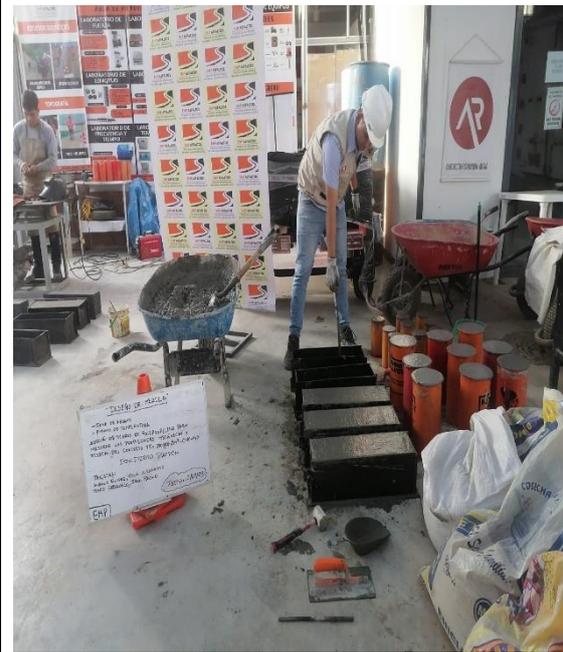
CHICLAYO. Elaboración de probetas, del concreto patrón, 2023.
